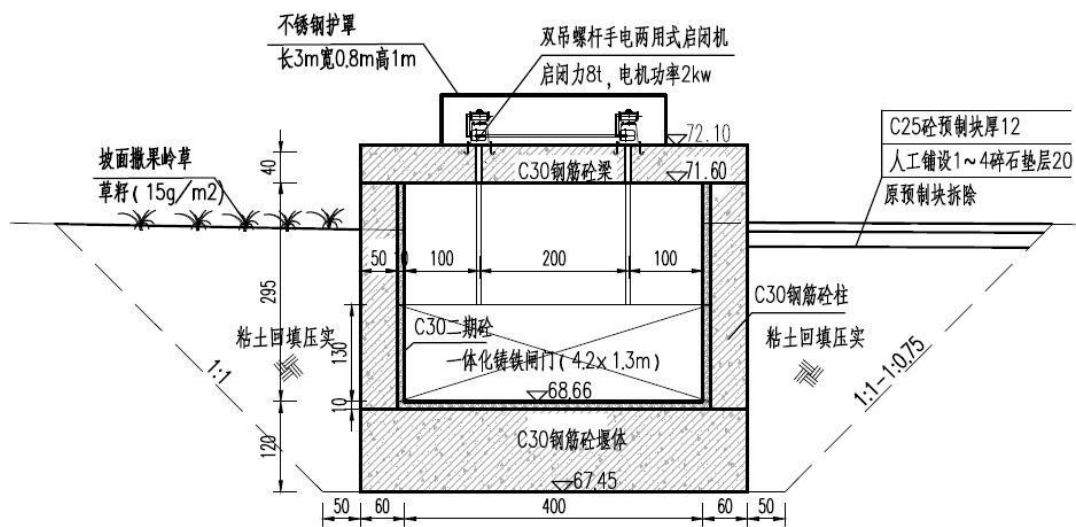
童家山水库溢洪道水闸 1-1 剖面图
